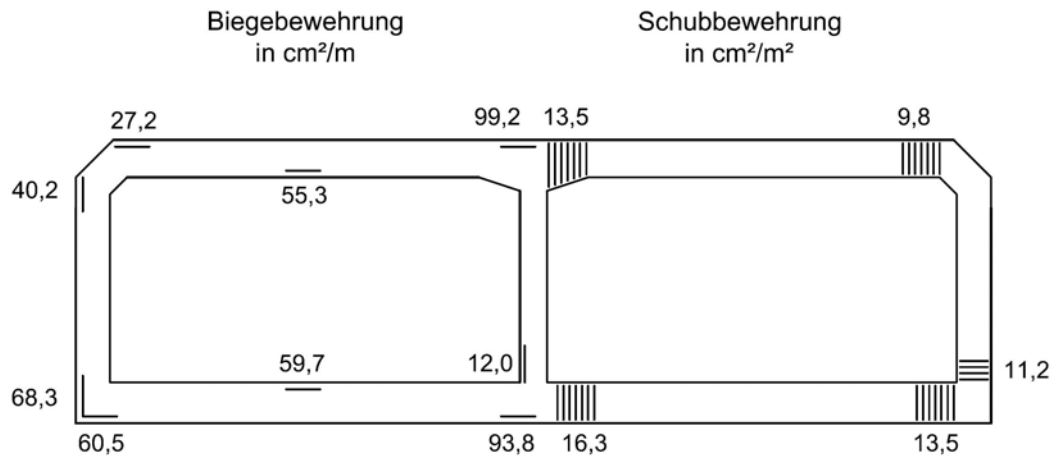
Erforderliche Biege- und Schubbewehrung
